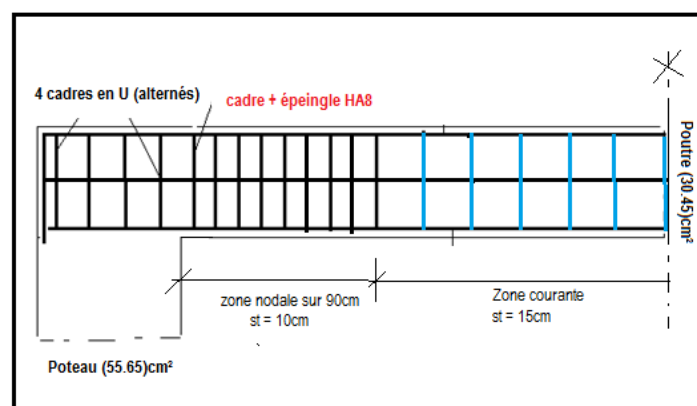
Coupe longitudinale du schéma de ferrailage des poutres.
